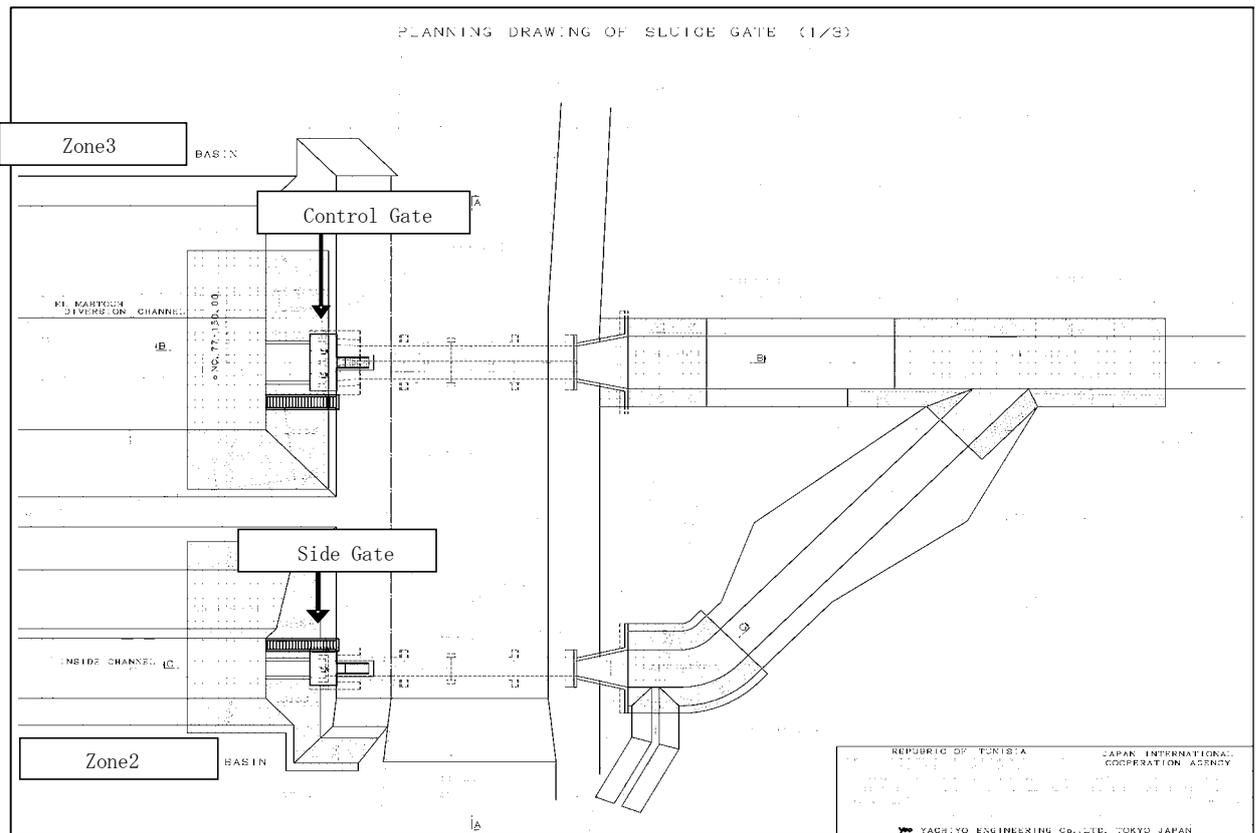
Plan général de l'ouvrage de contrôle de débit (1) Vue plane
